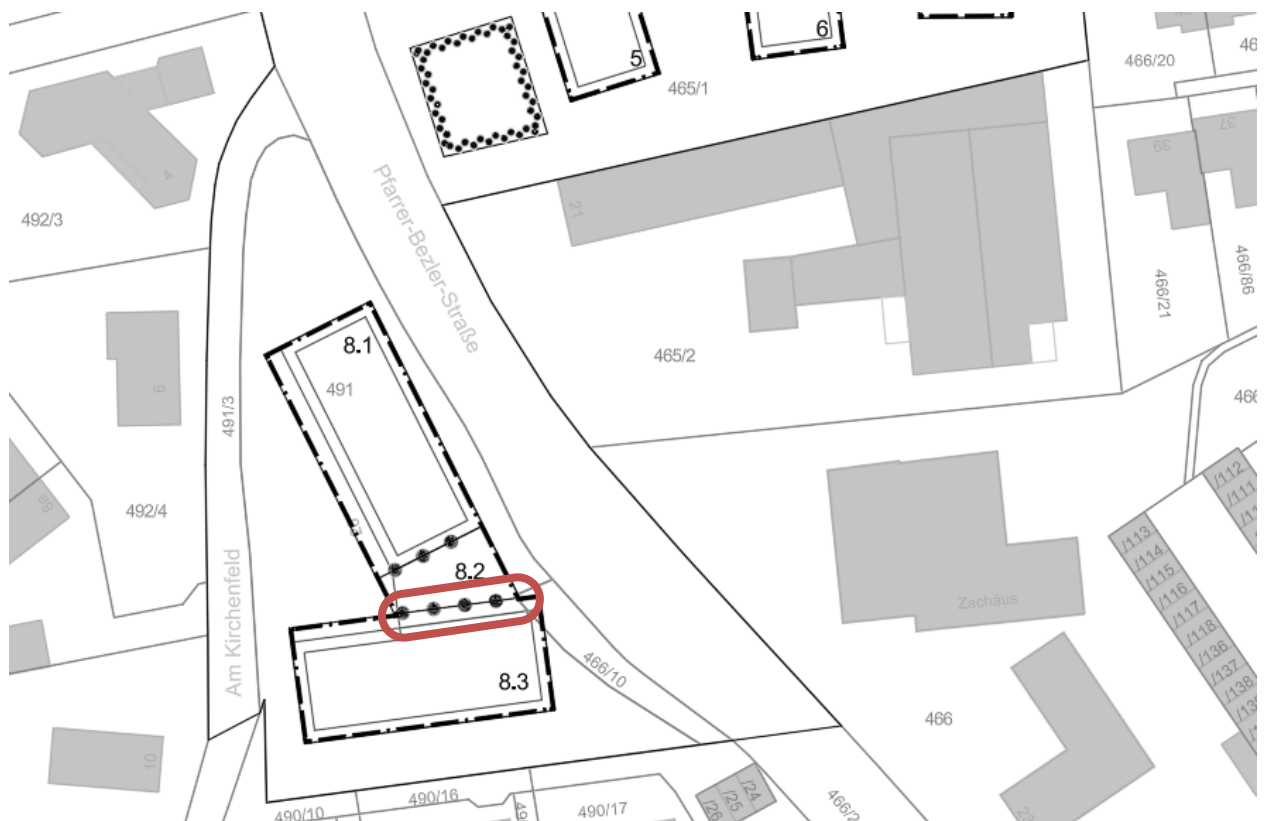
Bereich der Ausnahme des zurückversetzten Staffelgeschossen beim direkten Gebäudeanschluss im Baufeld 8.3 zum Baufeld 8.2
